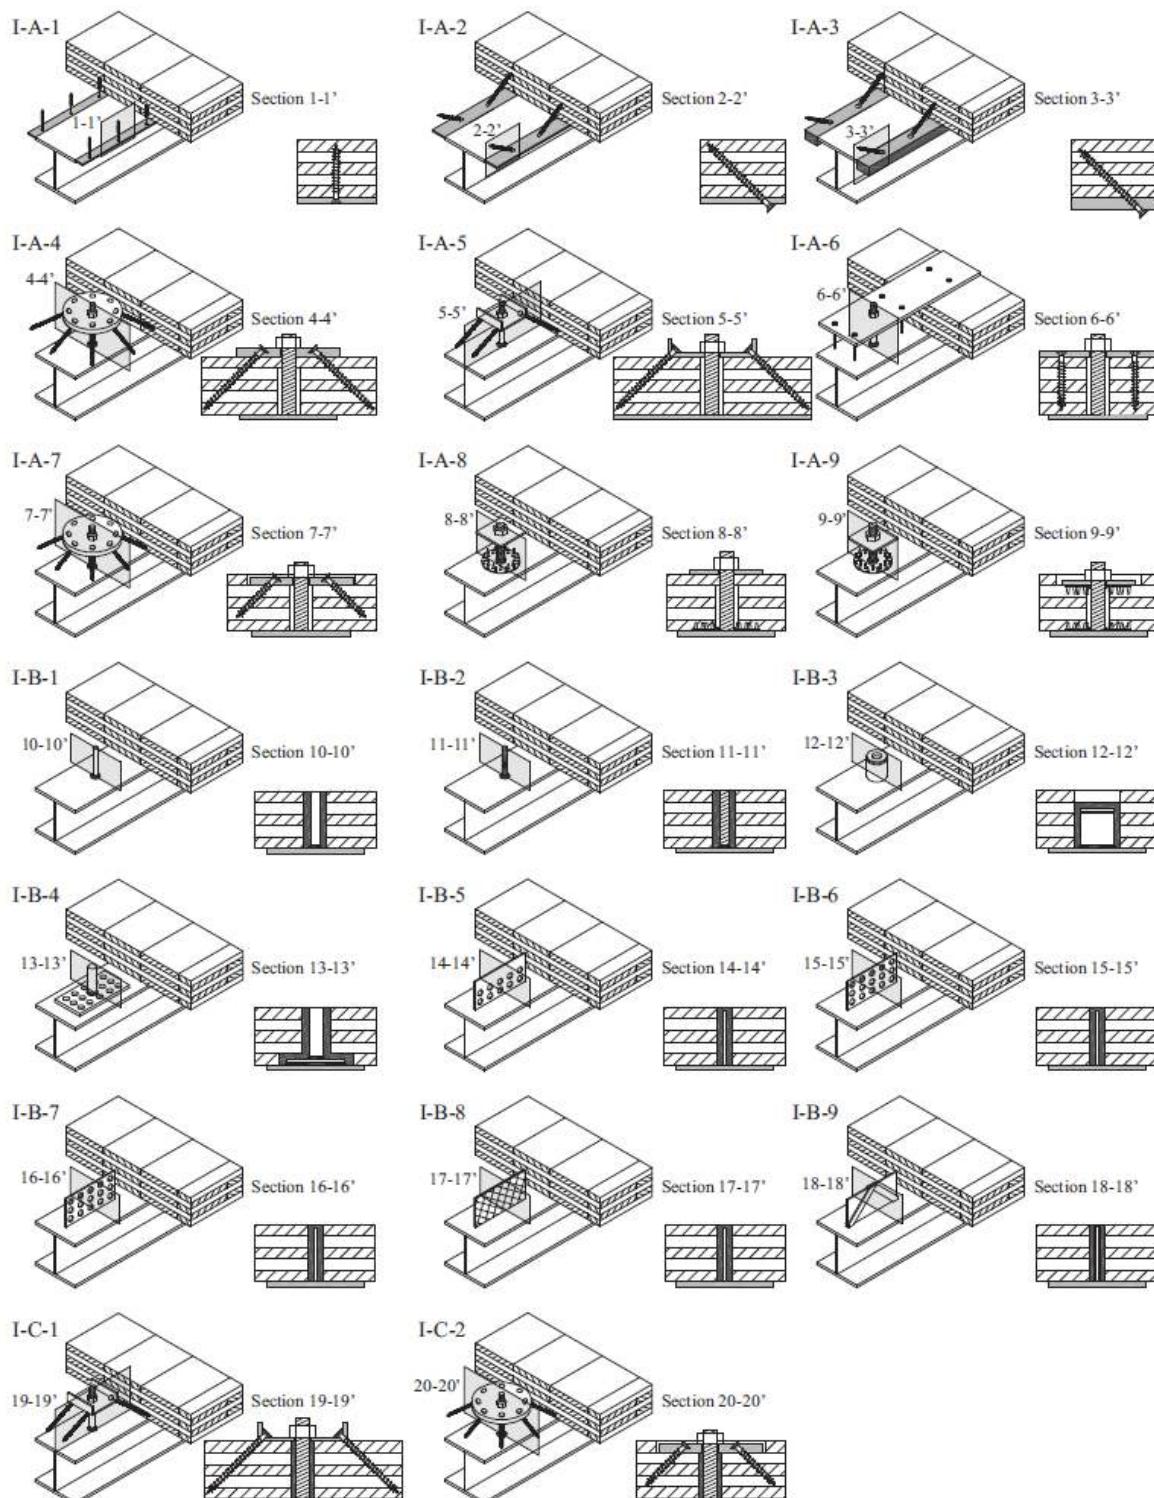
Connexions poutre-panneau pour les planchers et les murs de cisaillement mixtes acier-CLT [54]
